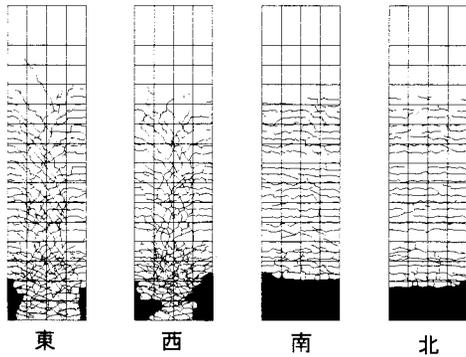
一体 RC 供試体ひび割れ図 $11\delta_y$
